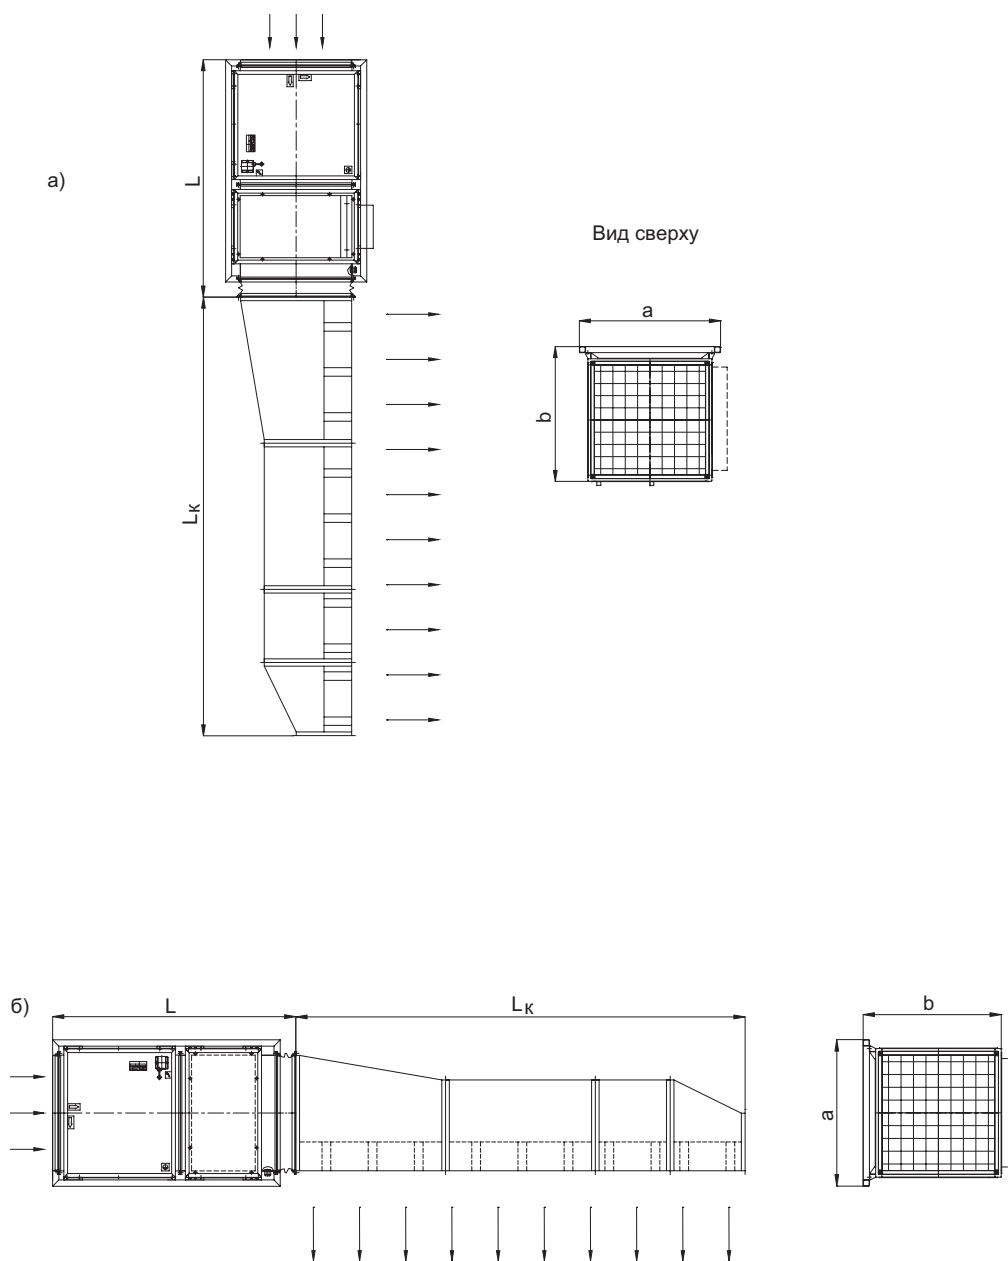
Габаритные размеры стандартных завес с «линейным» силовым блоком:
